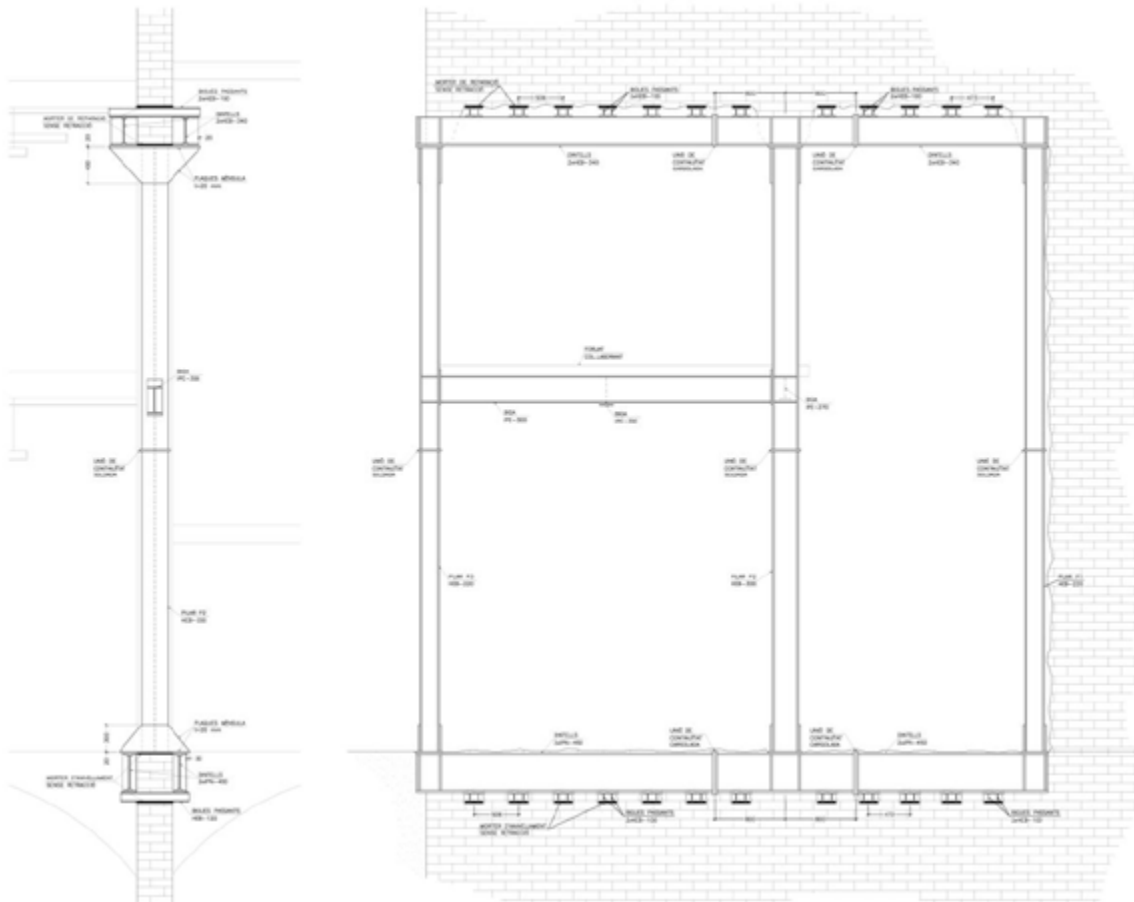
Importante apeo de pared mediante el sistema de pórtico rígido.
